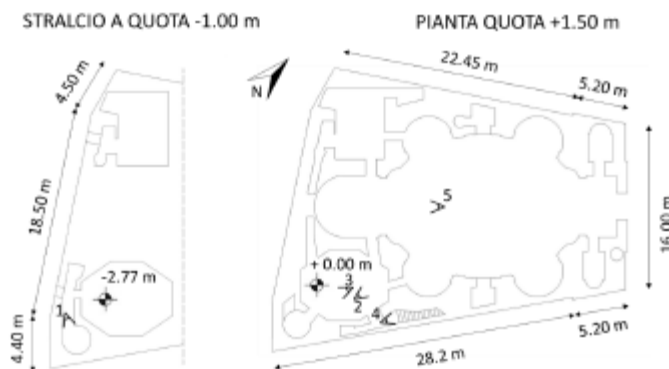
Planimetria a -1.00 m a sinistra, a + 1.50 m a destra
